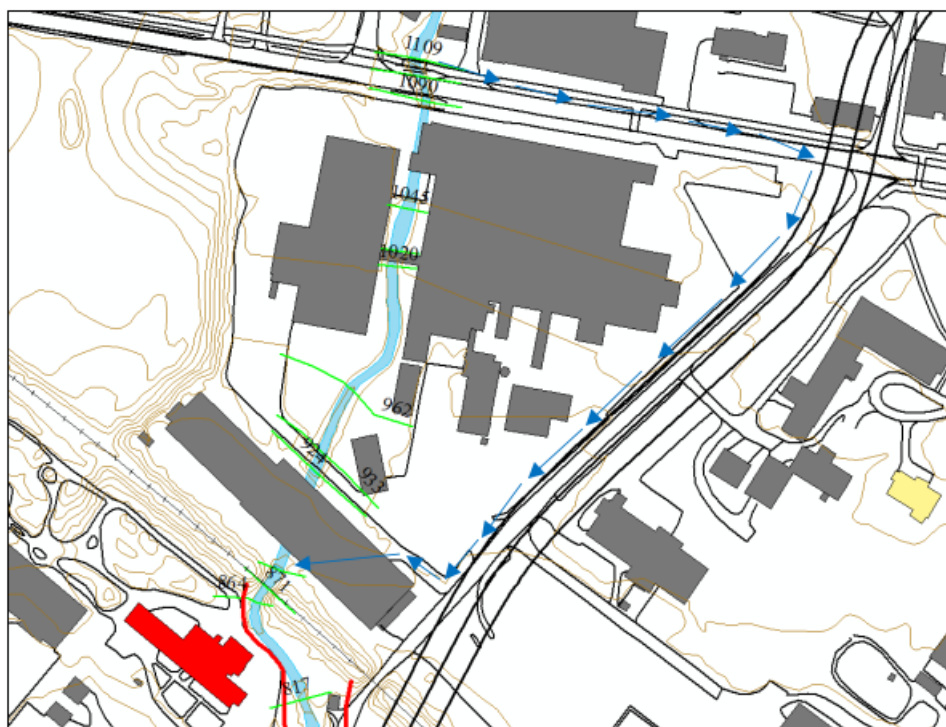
Plassering av foreslått flaumkulvert (svarte linjer) gjennom eksisterende kryssing av Dovrebana. Bakgrunnskart er utsnitt fra førebels illustrasjonsplan for Strandsagvegen.
